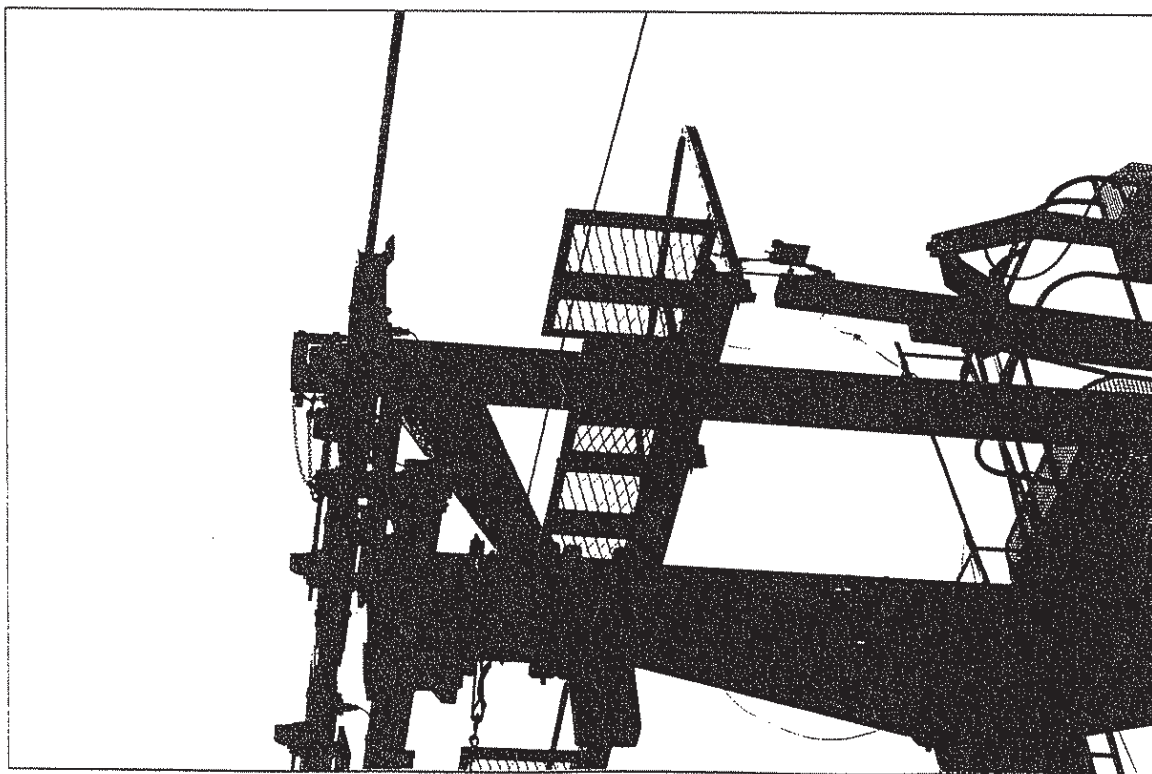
Posizionamento del potenziometro lineare per la misura dello spostamento della traversa
